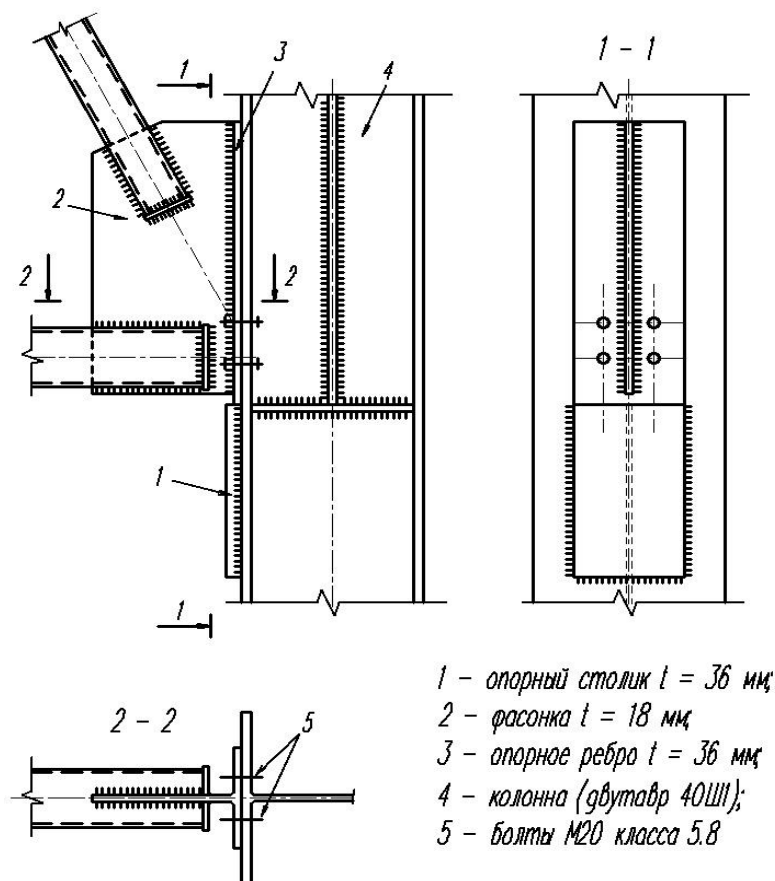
Опираие на колонну в уровне нижнего пояса фермы
